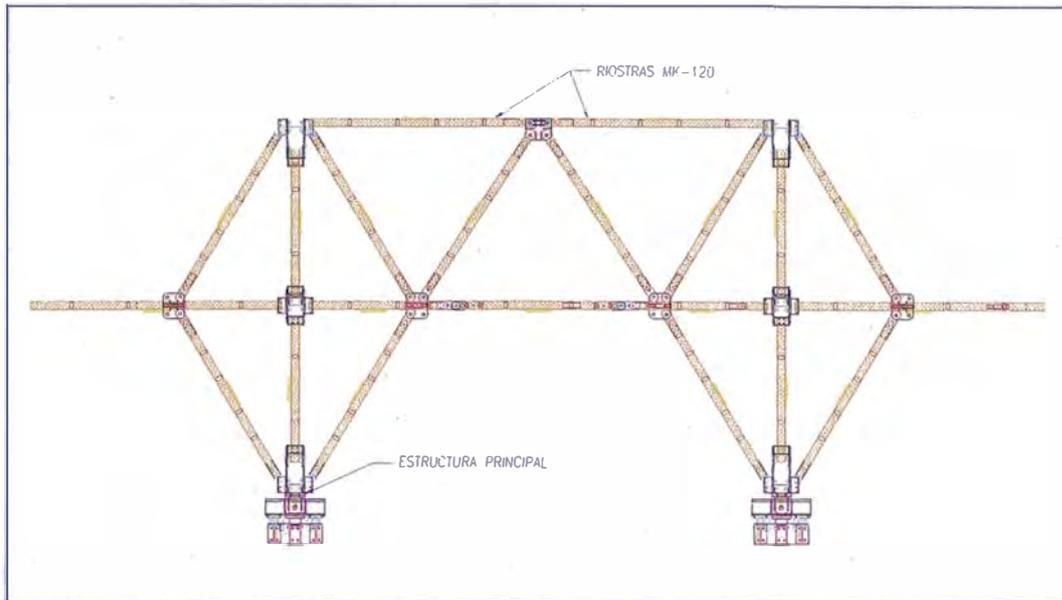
Arriostres MK-120 de las Estructuras Principales - Fuente: Elaboración Propia
